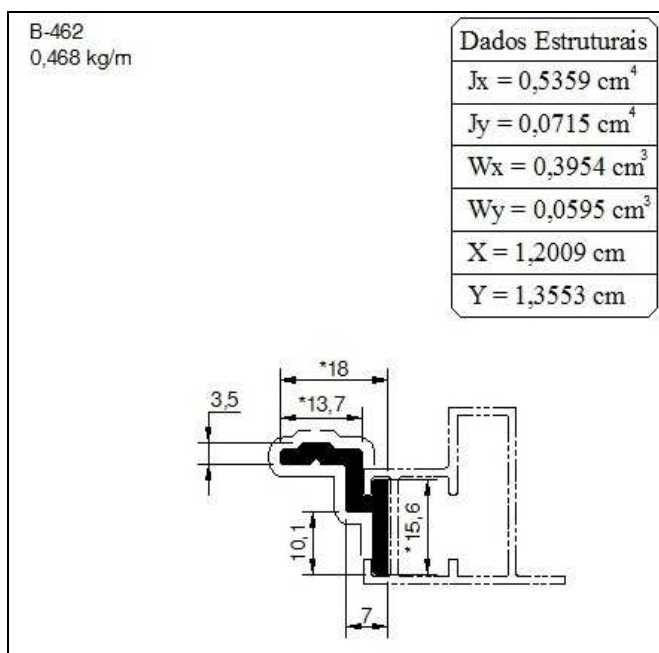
Presilha de fixação da folha. Cotas em mm.
